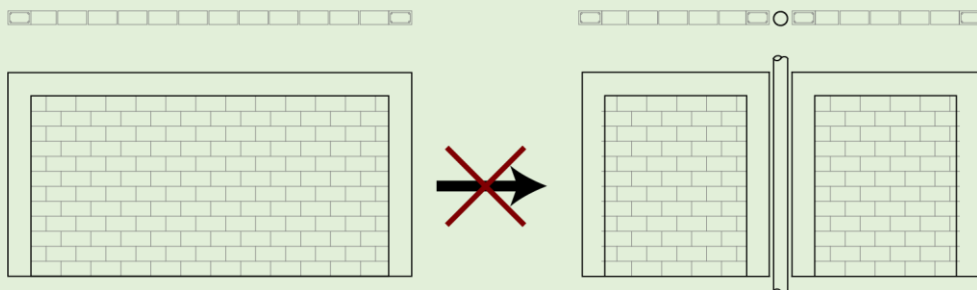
División de muros en obra para acomodar tubería, no considerada en el proyecto estructural.
